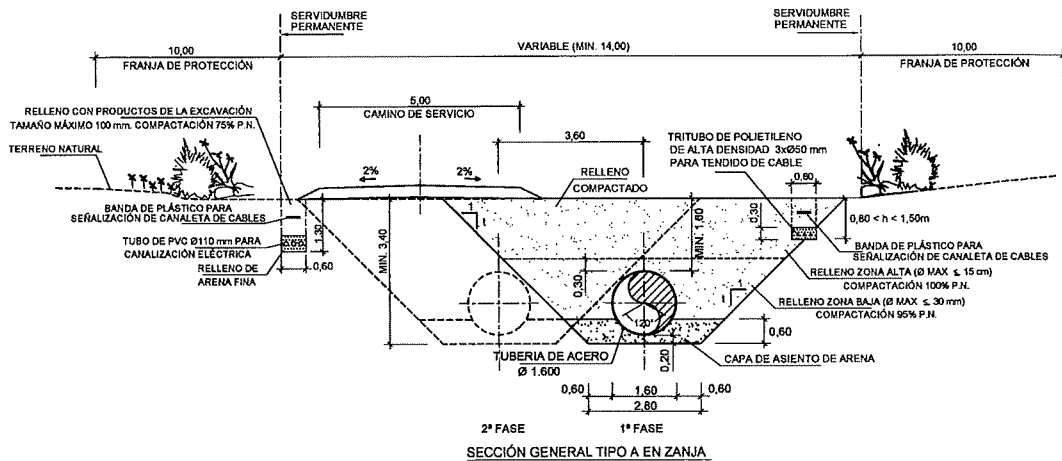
Sección general tipo zanja sin dado de hormigón (RB.2)
